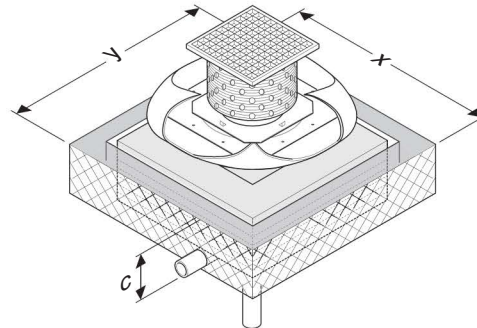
Aussparung Geberit Pluvia Dachwassereinlauf
